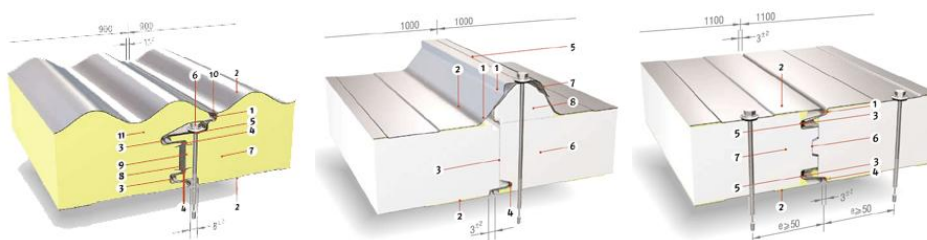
Beispiele für Dach- und Fassadensysteme (Sandwichpaneele)
